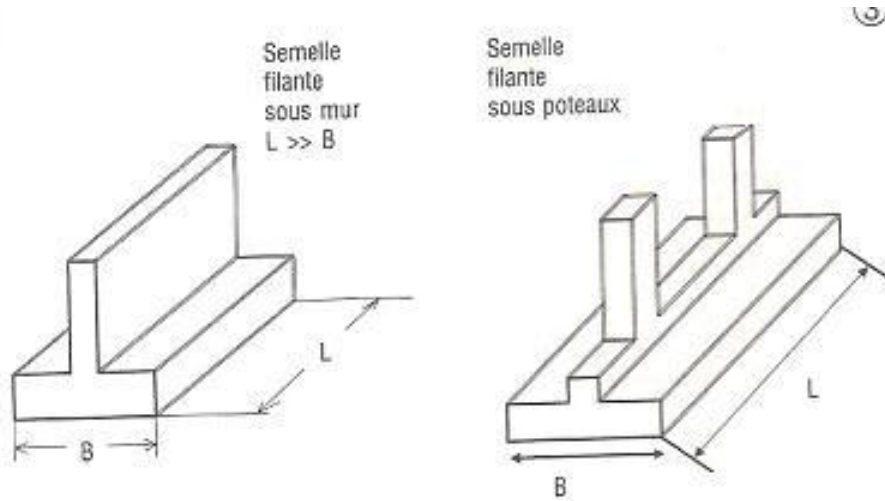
semelle filante sous mur et semelle filante sous poteaux
